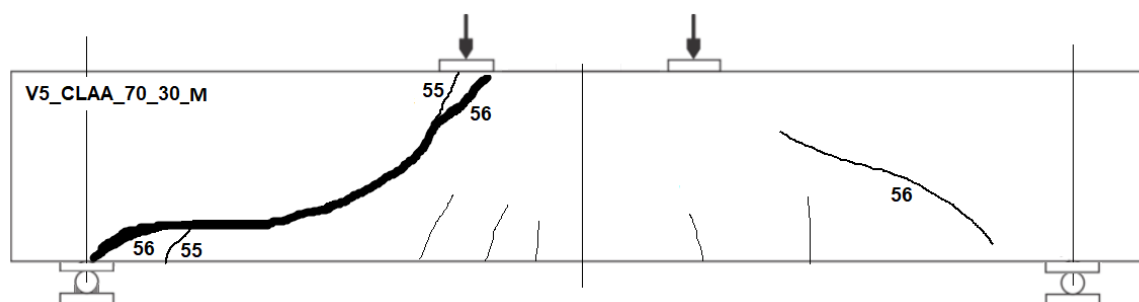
Esquema de fissuração da Viga 5_CLAA_70_30_M.
